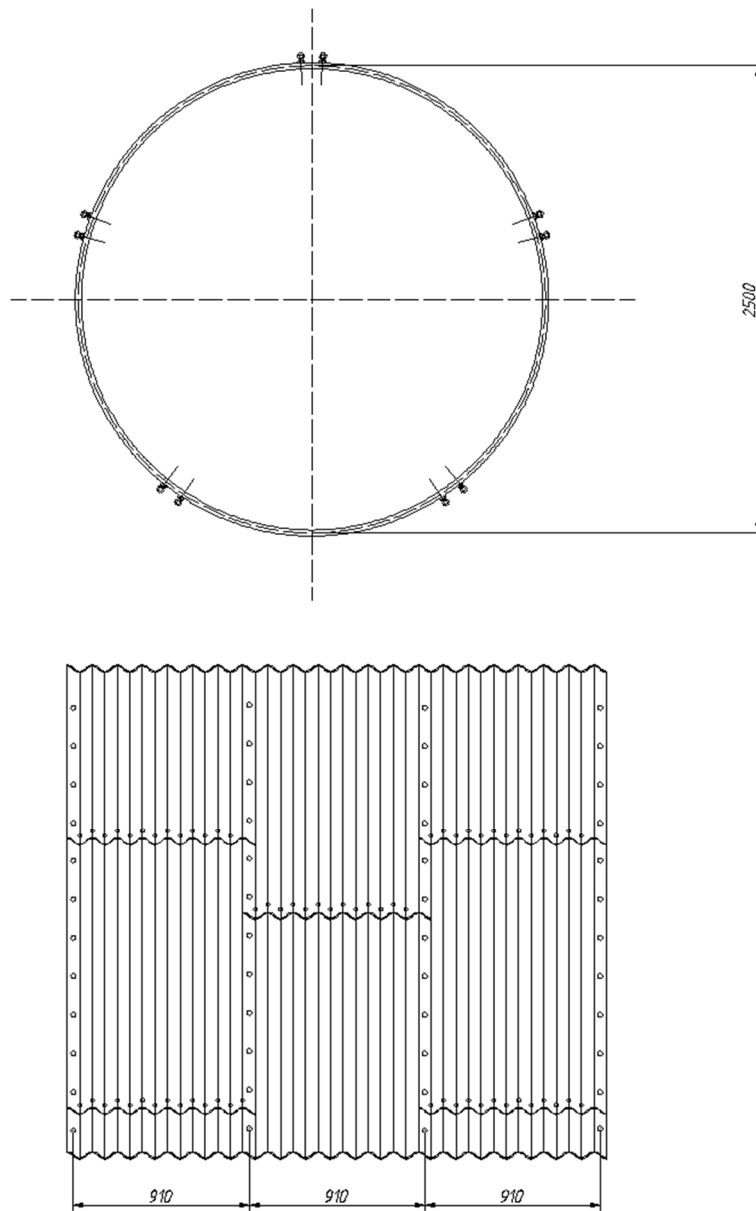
Раскладка листов – сборочный чертеж
